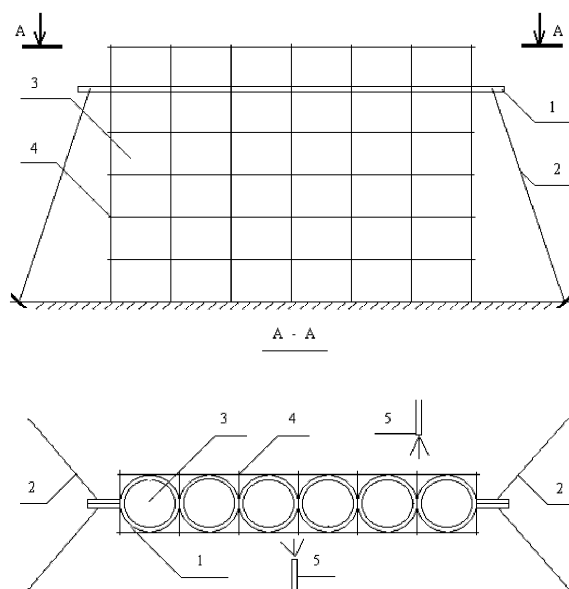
Схема выполнения работ при бетонировании ограждающих конструкций на модульной опалубке: 1 – хомут для скрепления модулей; 2 – подкосы; 3 – пневмомодуль; 4 – монтажные каркасы; 5 – сопло торкрет-установки
